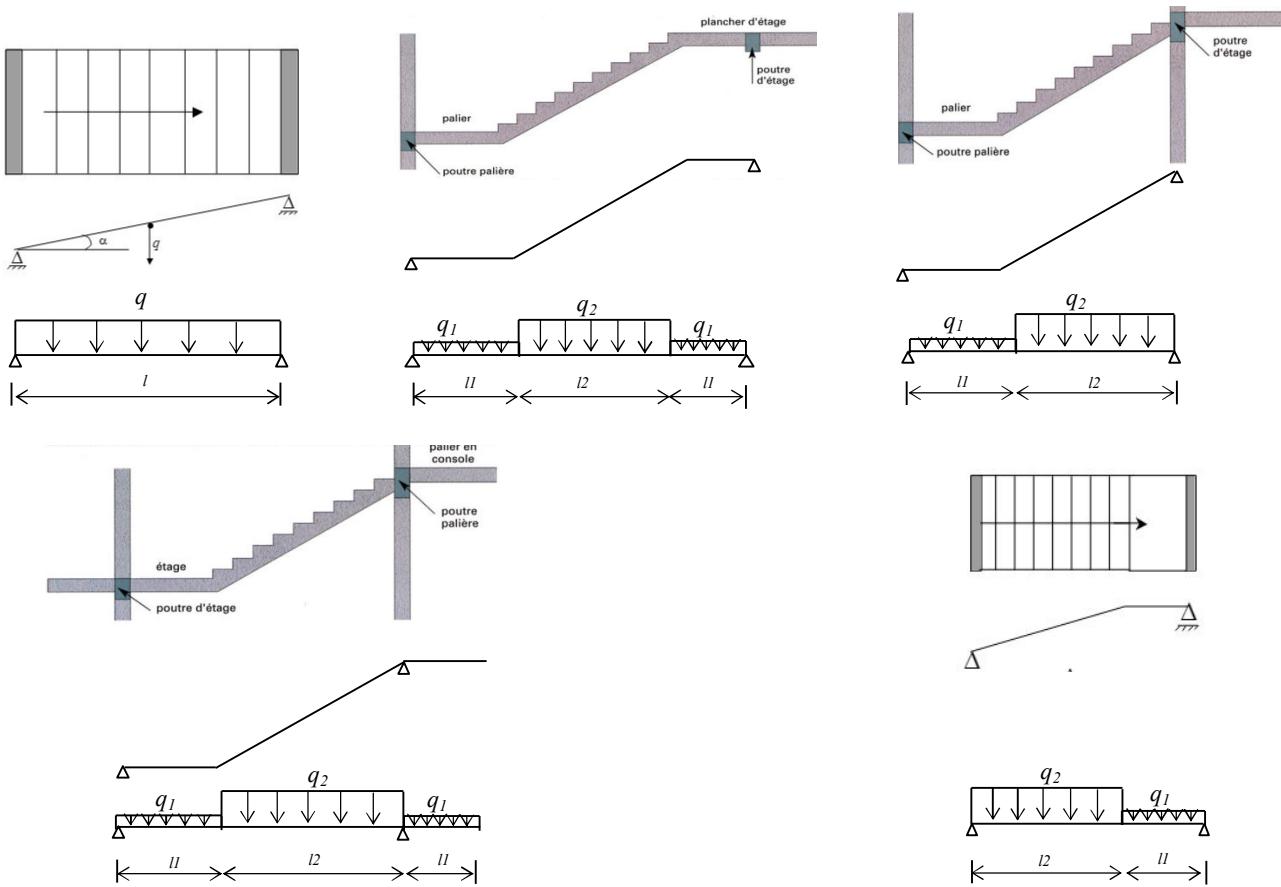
Schémas de calcul d'escaliers à paillasse droite
